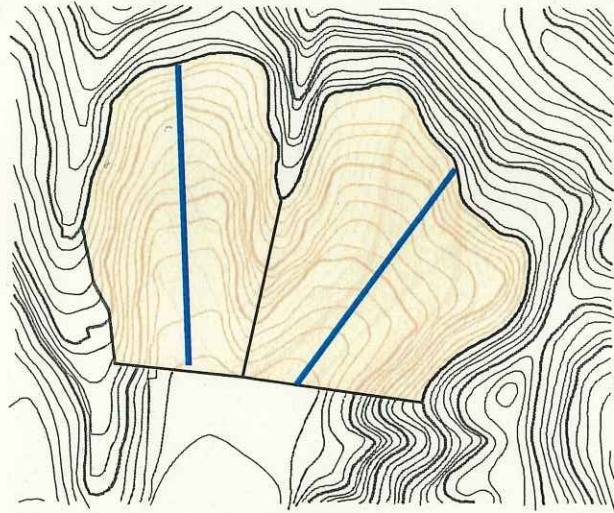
尾根が埋没した盛土ブロックの区分（平面図）
